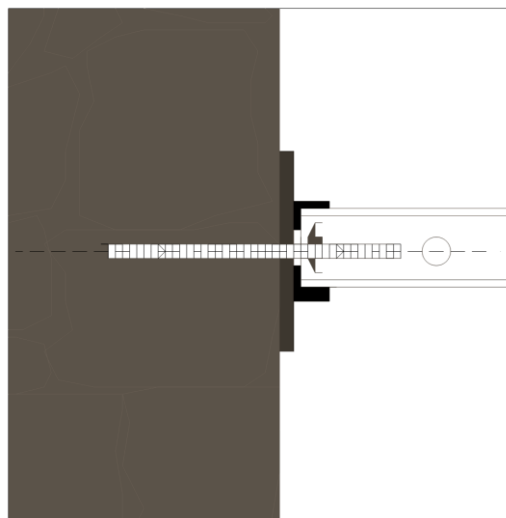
Detalle de anclaje de las correas a la fachada.
